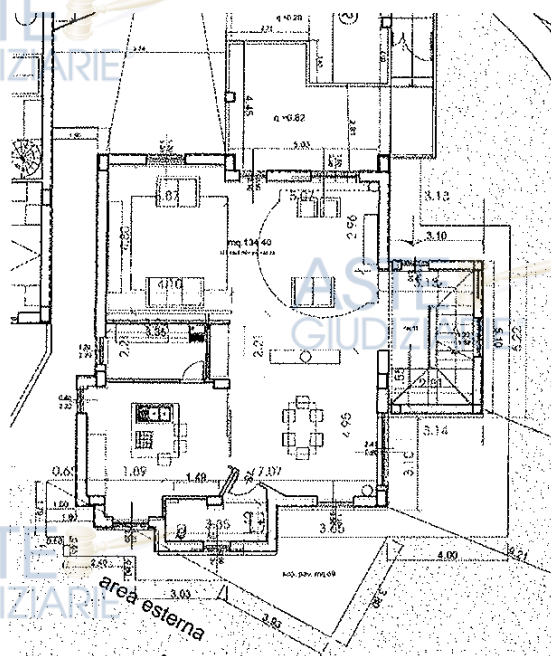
Piano Terra - sovrapposizione stato attuale con i disegni del Permesso di costruire
